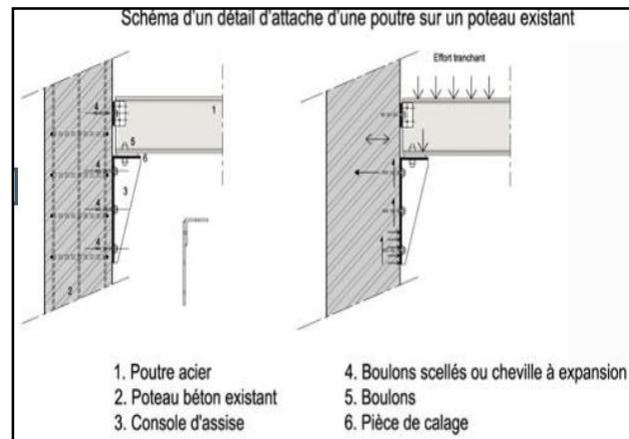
schéma de jonction d'un poteau a une poutre métallique
